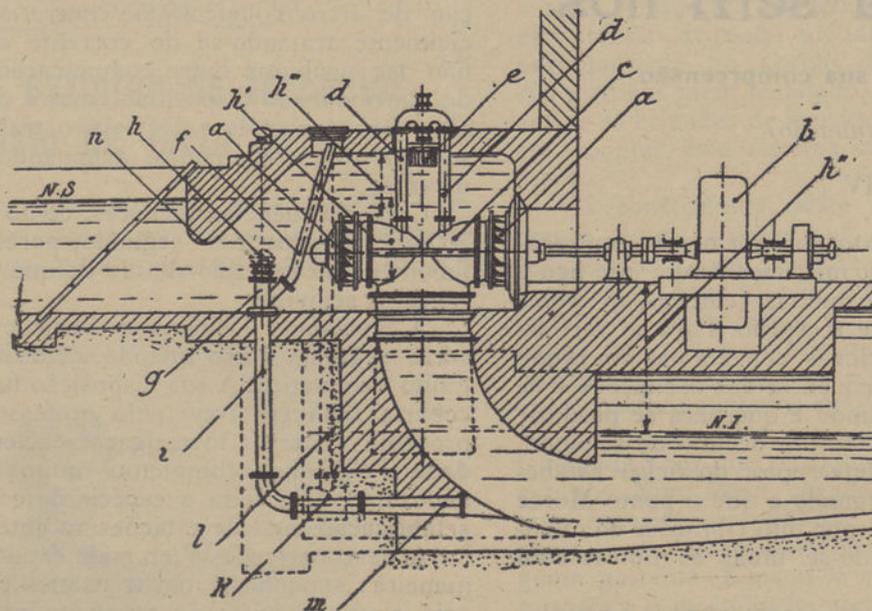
Turbina hidráulica de sifão de eixo horizontal
